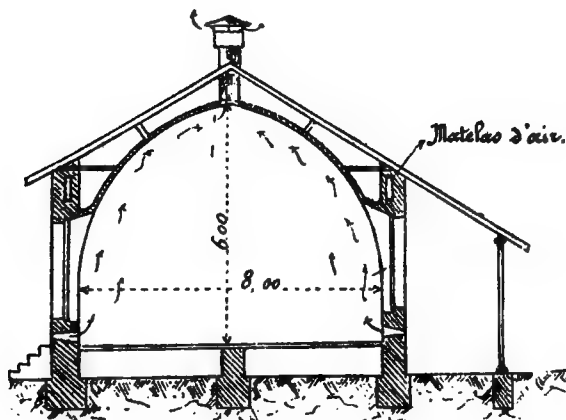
Coupe d'un pavillon à rez-de-chaussée (Tollet).
